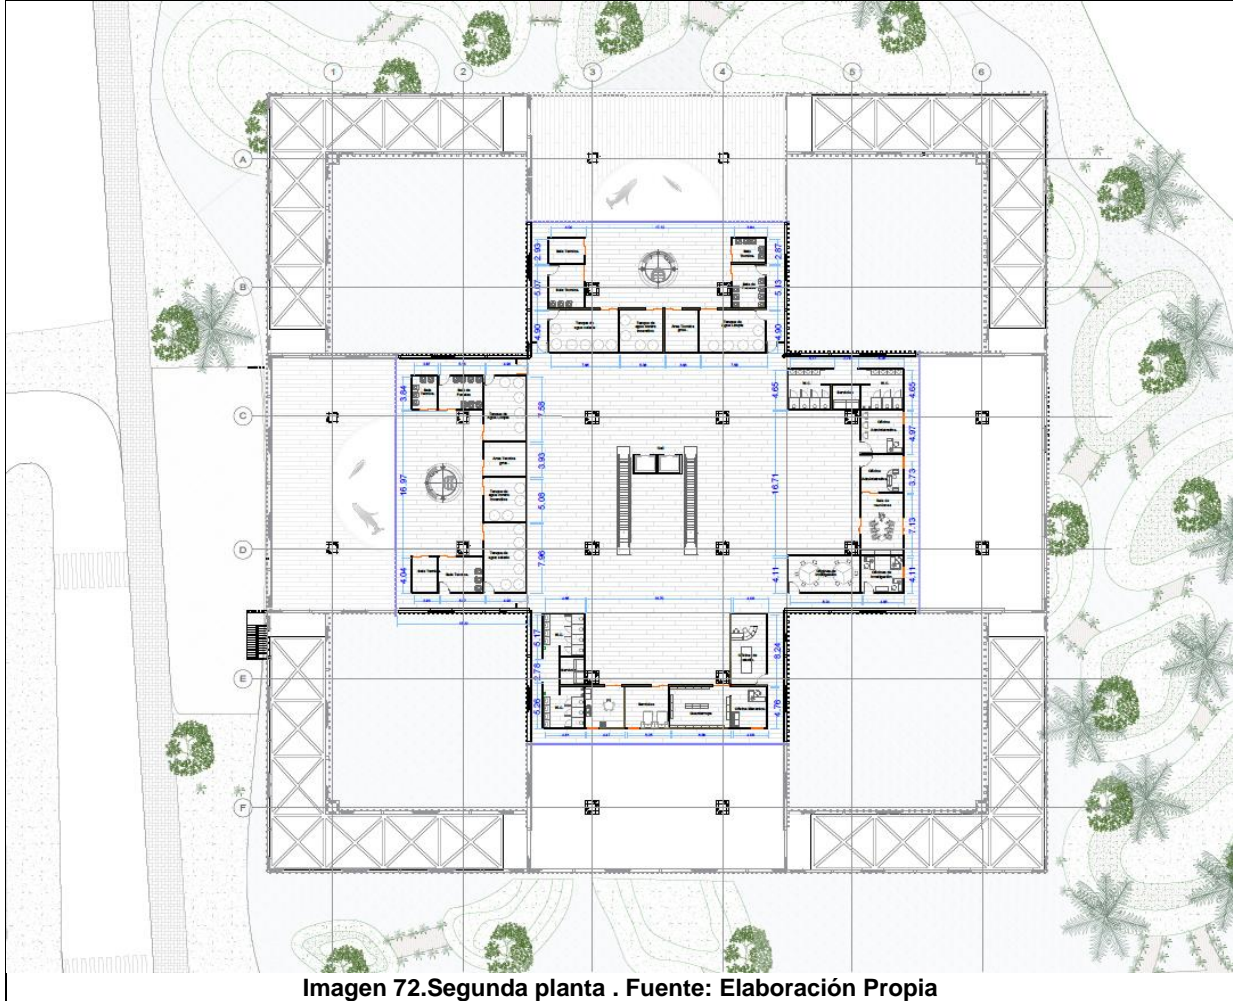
Segunda planta . Fuente: Elaboración Propia
